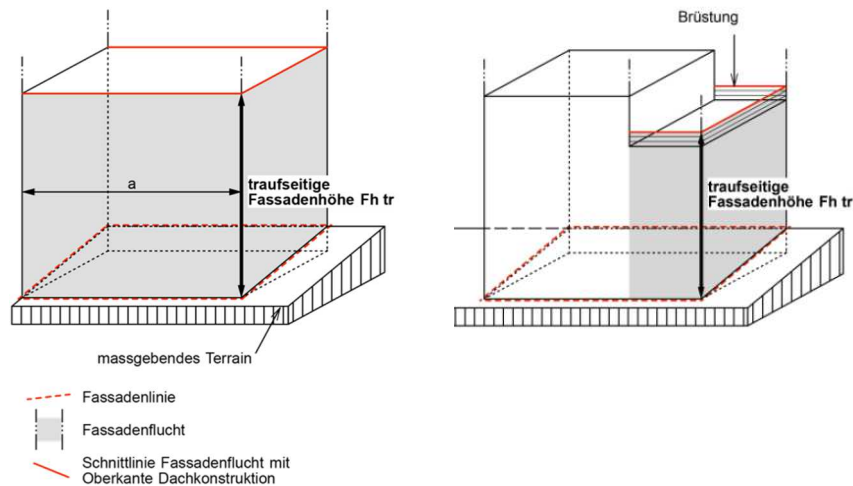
Skizze Art. 37 Abs. 4 Bst. b) BauR
